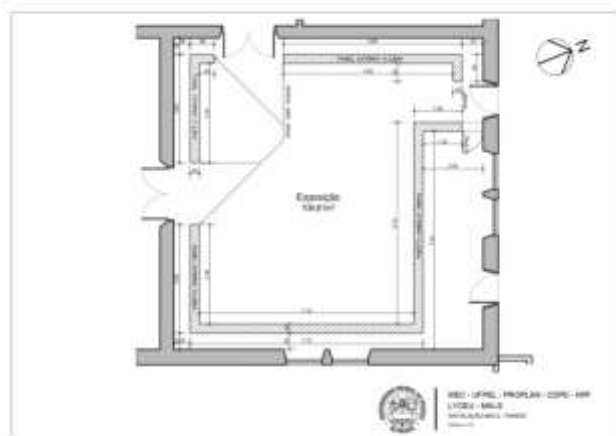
Planta Baixa Galeria Marina de Moraes Pires.
